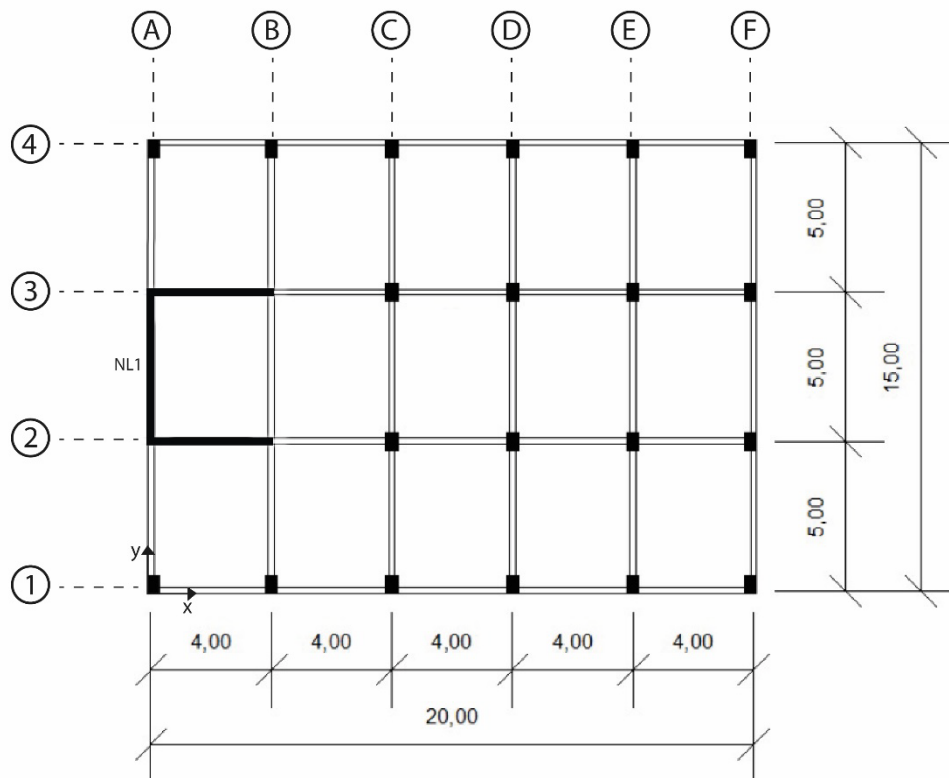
Planta modificada do edifício 2NL8, utilizada neste trabalho.
